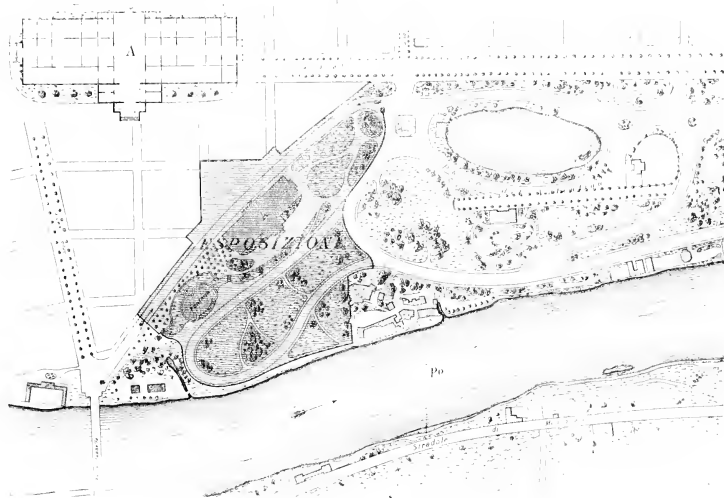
Plan de l'Exposition internationale de Turin. A. Plan des Serres.
